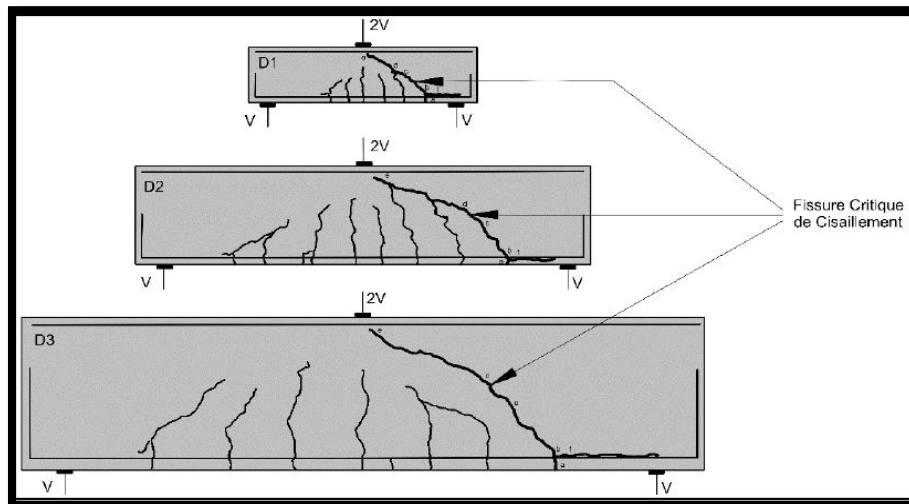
Profil de fissuration des poutres (Belbachir, 2011).
